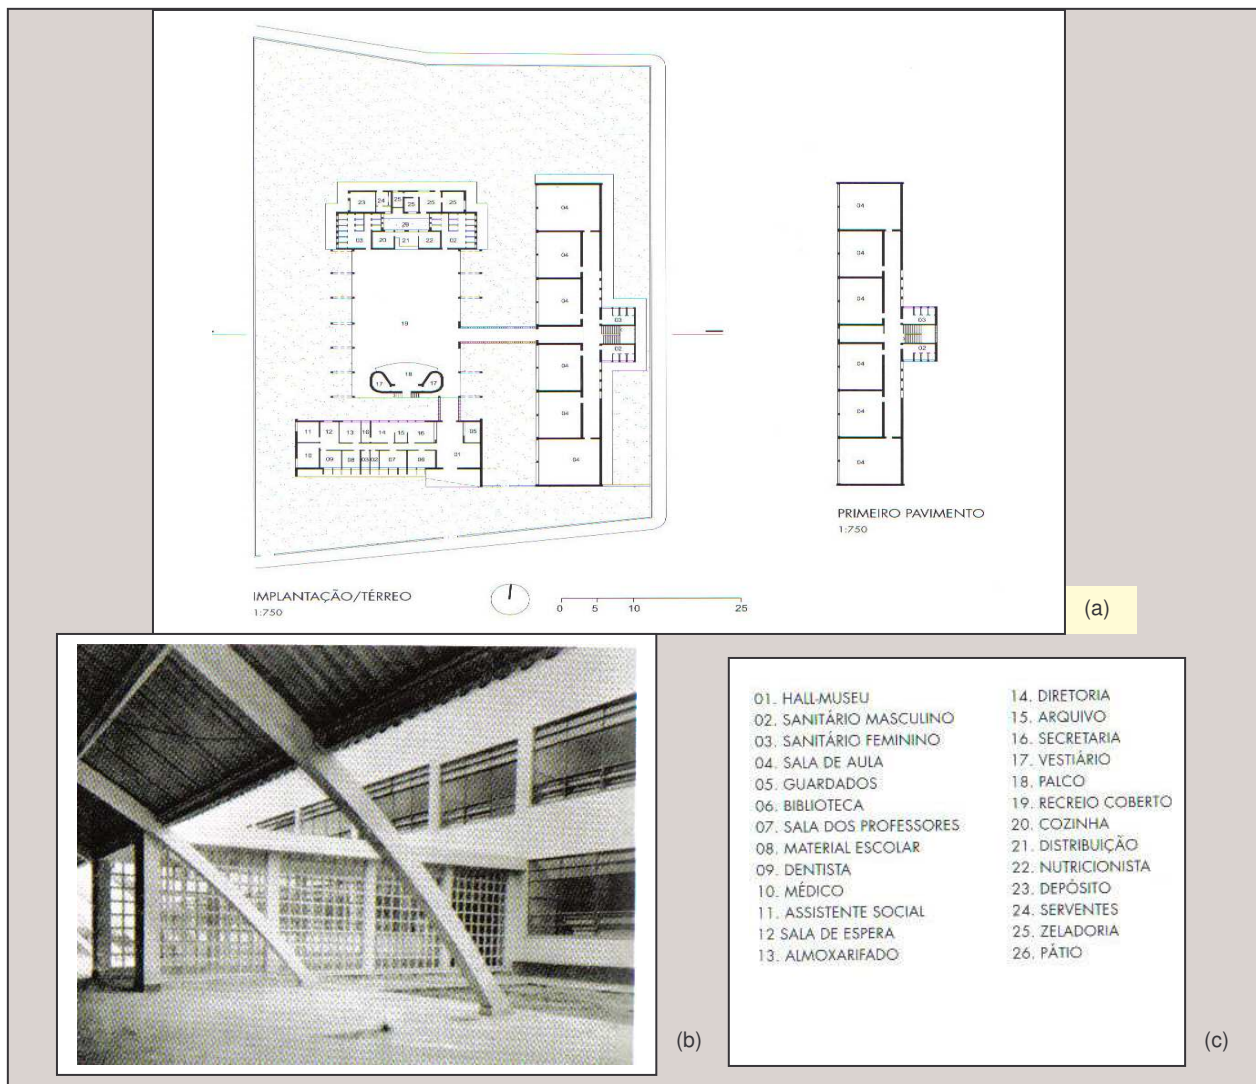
Grupo Escolar Visconde de Taunay (1951), de autoria de Hélió Duarte. Em (a): da plantas baixas do pavimento térreo e superior; (b): foto da fachada; (c): legenda.
